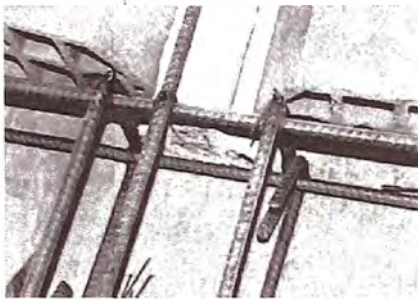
Ensayo Monotónico y Cíclico conexión viga-viga chata
